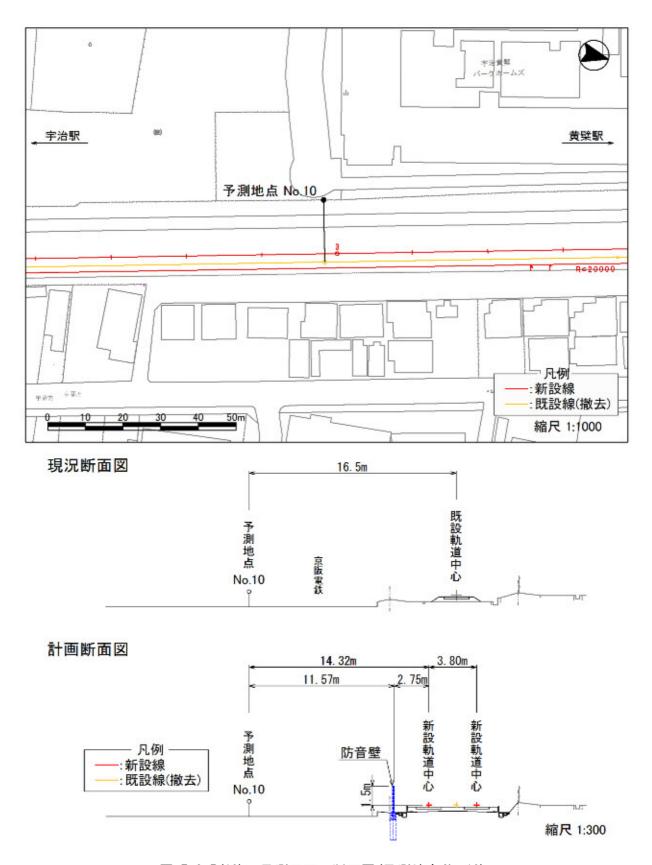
(10) 予測平面・断面図(予測地点 No.10)
